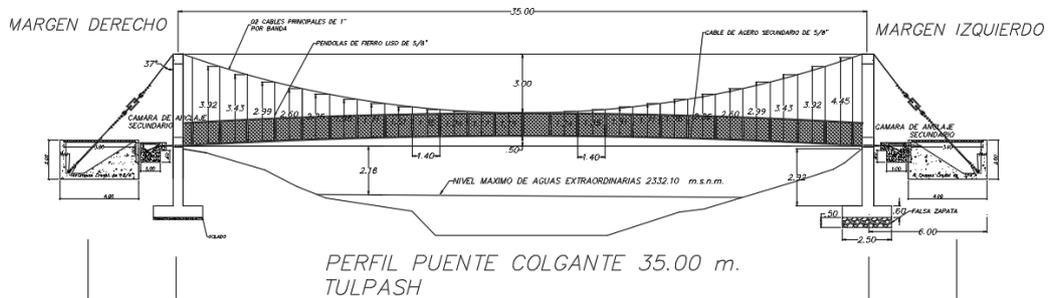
Perfil del puente Colgante – Típico diseñado (fuente: Propio)
